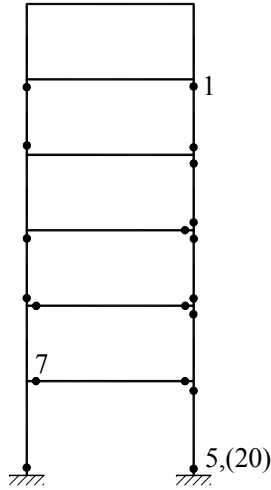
Altı katlı betonarme düzlem çerçeve sistem ve işletme yükleri
